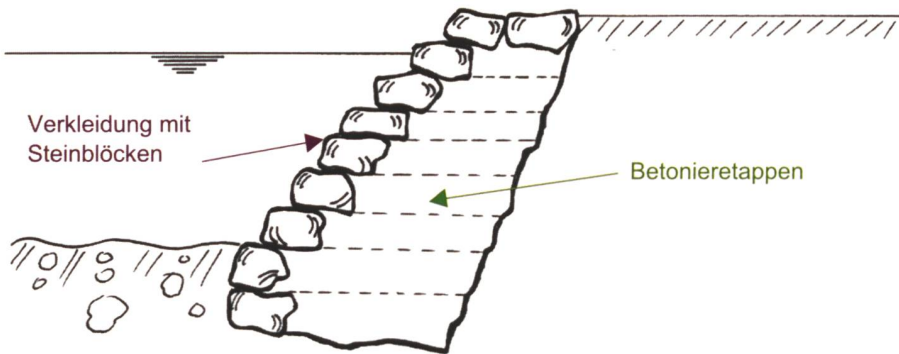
Mit Steinblöcken abgeschaltete Schwergewichtsmauer. Schichtweises Betonieren direkt gegen die Aushubböschung (evtl. Verwendung von Walzbeton).
